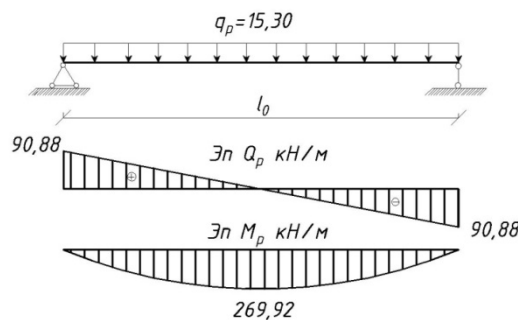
Эпюры моментов и поперечных сил от расчетной нагрузки.
